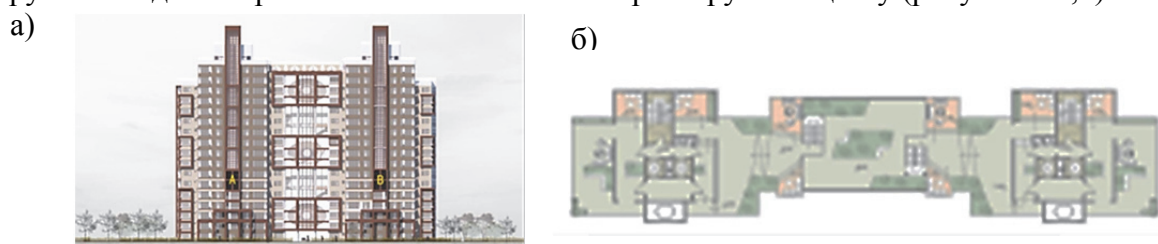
а) внешний вид здания; б) план сада на крыше
